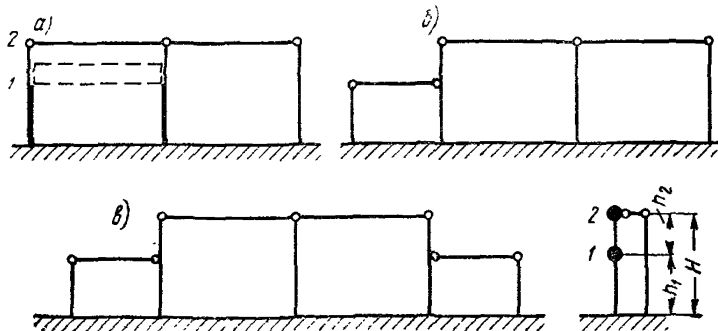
Схемы одноэтажных рам с шарнирными узлами, у которых нижние ригели (или мостовые краны) опираются не на все стойки
